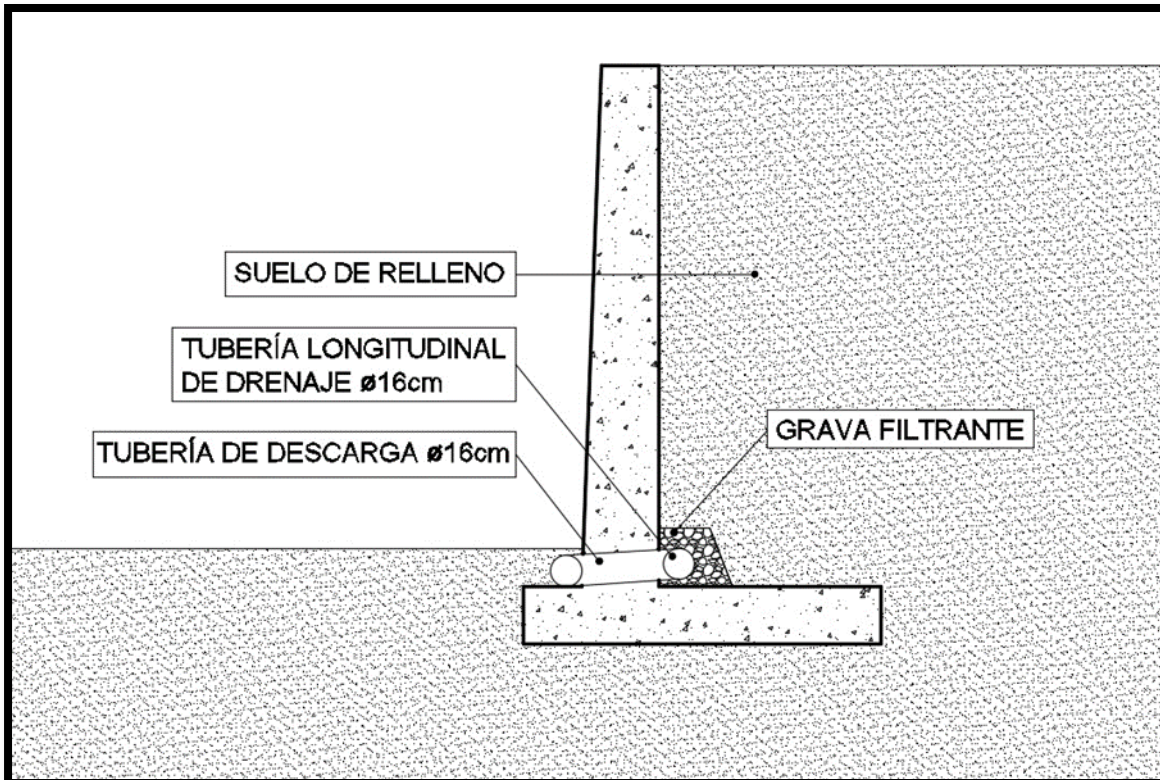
Esquema del sistema de drenaje del muro (fuente: elaboración propia).
